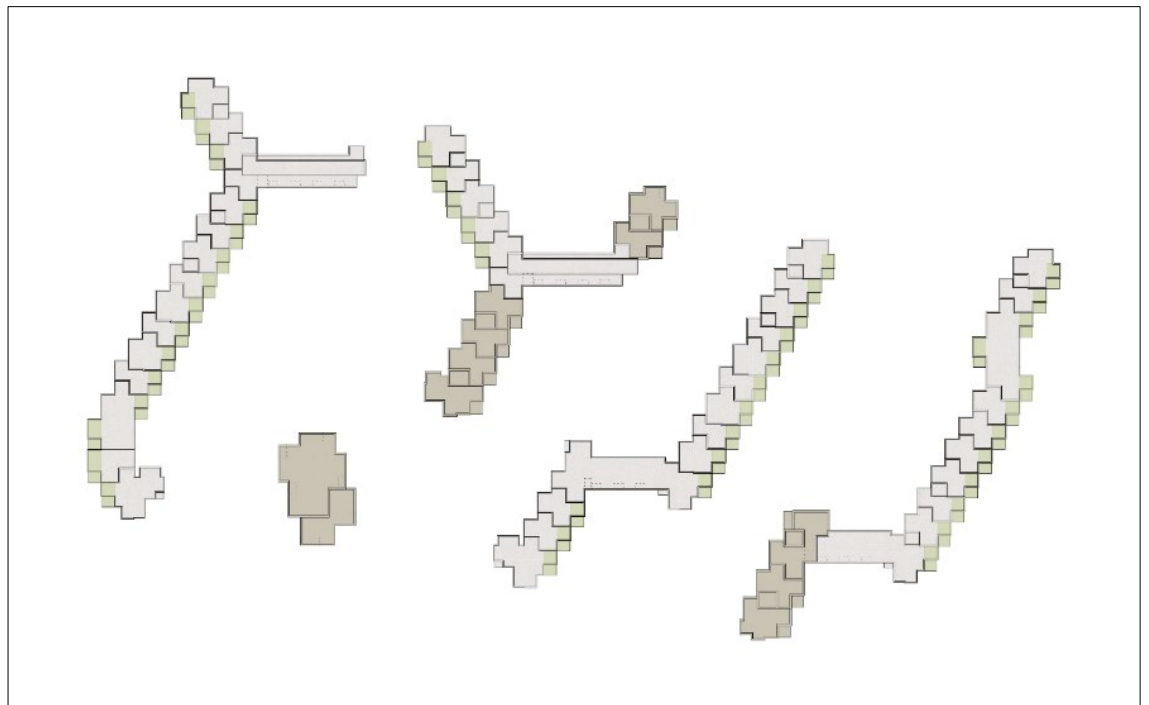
Siedlungsplan mit den geplanten Verdichtungseingriffen. Legende: Instandsetzung Erweiterung Neubau
